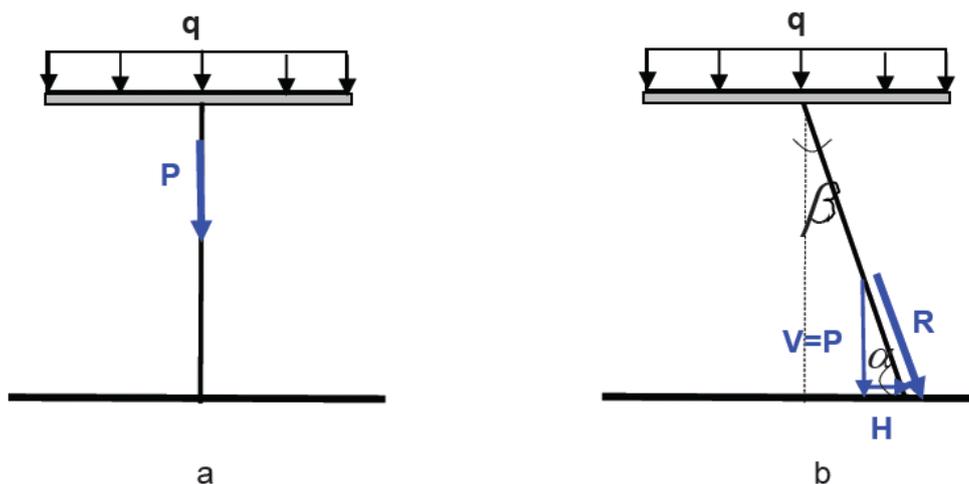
Axil en puntal inclinado según ángulo de inclinación (α).
